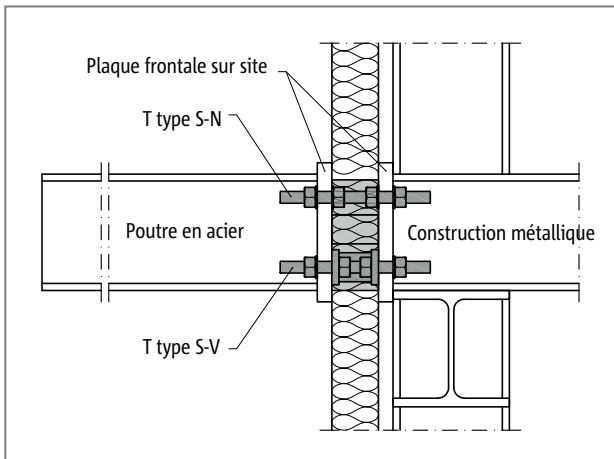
Schöck Isokorb® T type S-N et T type S-V : construction en acier en porte-à-faux libre
